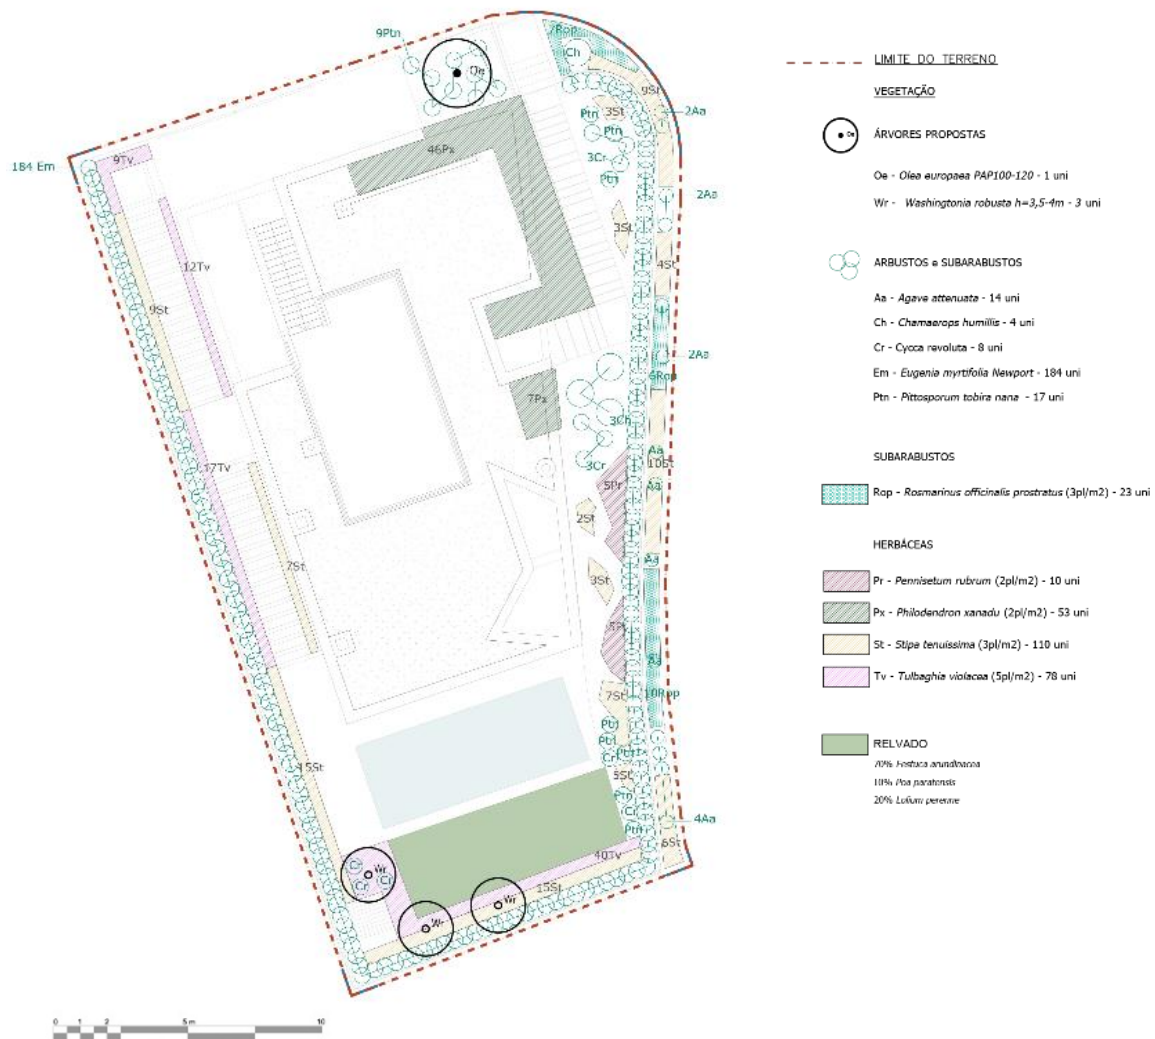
Plano de Plantação do Lote 11 em Porto Mós, Lagos e respetiva legenda. Fonte: Autora, 2022.
